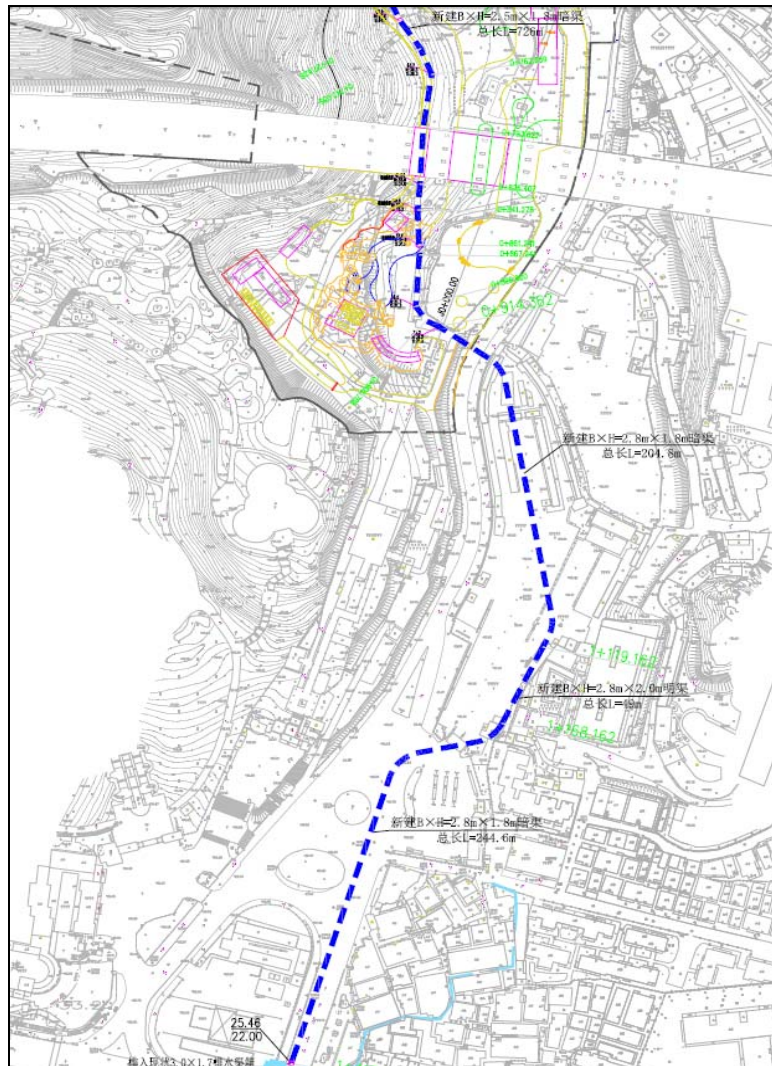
蒲谷—麓湖分洪工程平面布置图三
